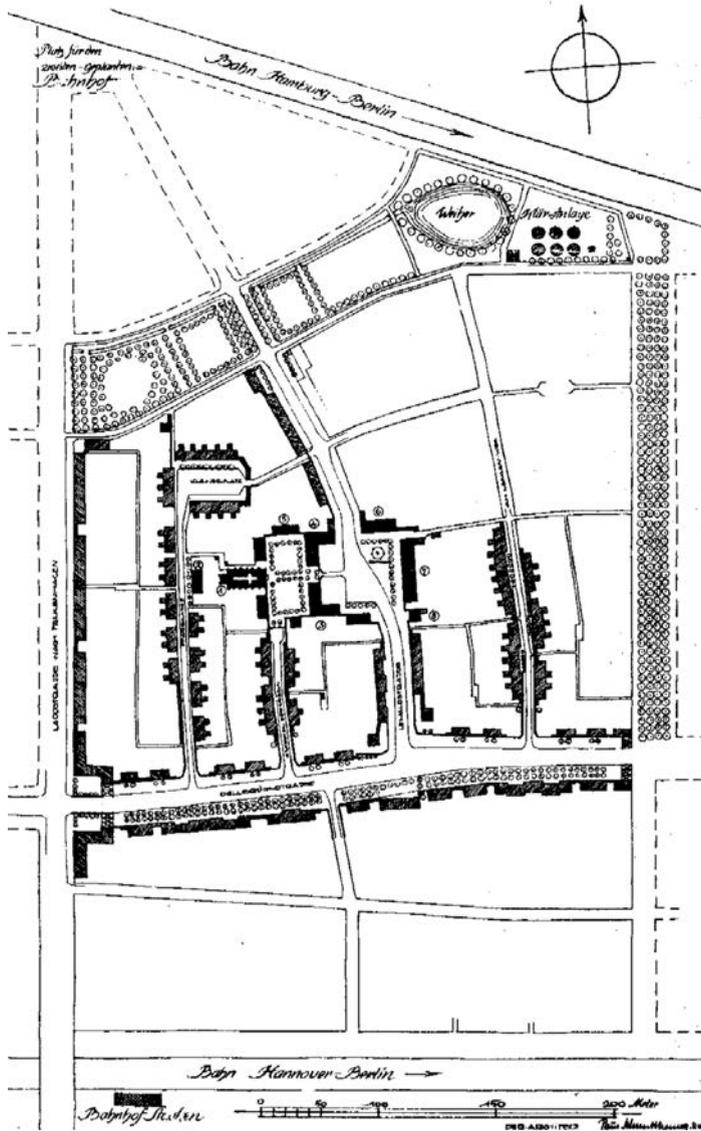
Bebauungsplan Gartenstadt Staaken von Paul Schmitthenner (1913)
